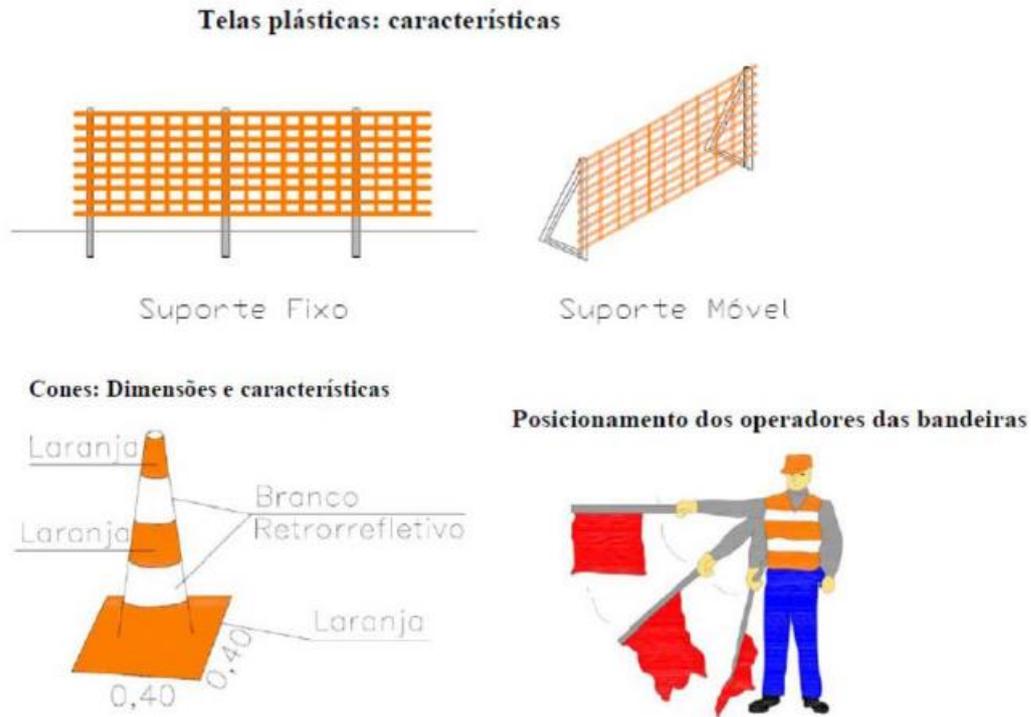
Disposição de Dispositivos – Serviços em Pista
